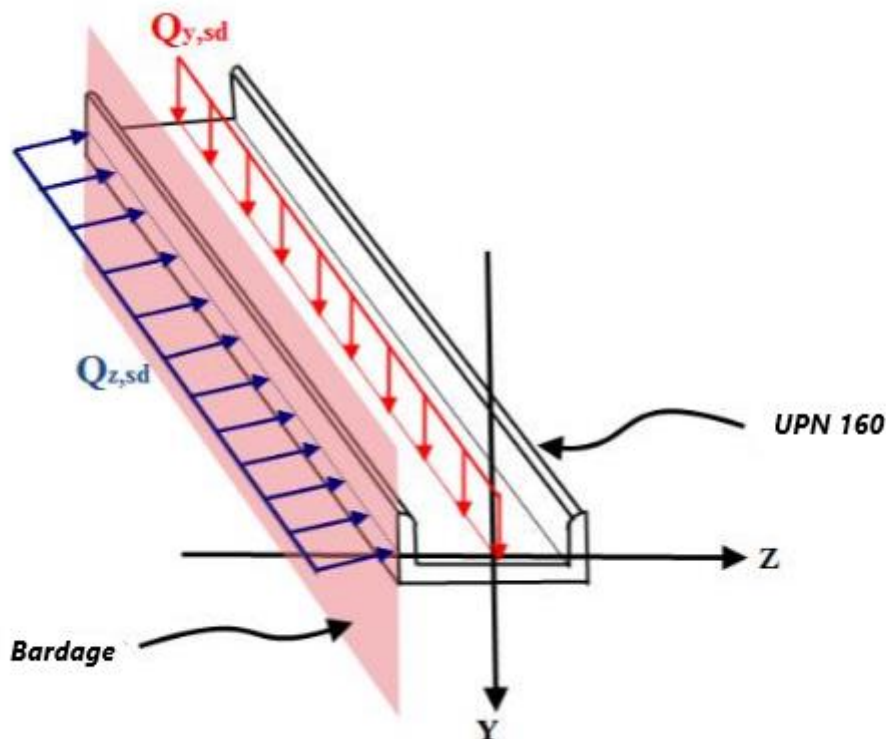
Semelle comprimée soutenue sur toute sa longueur.
